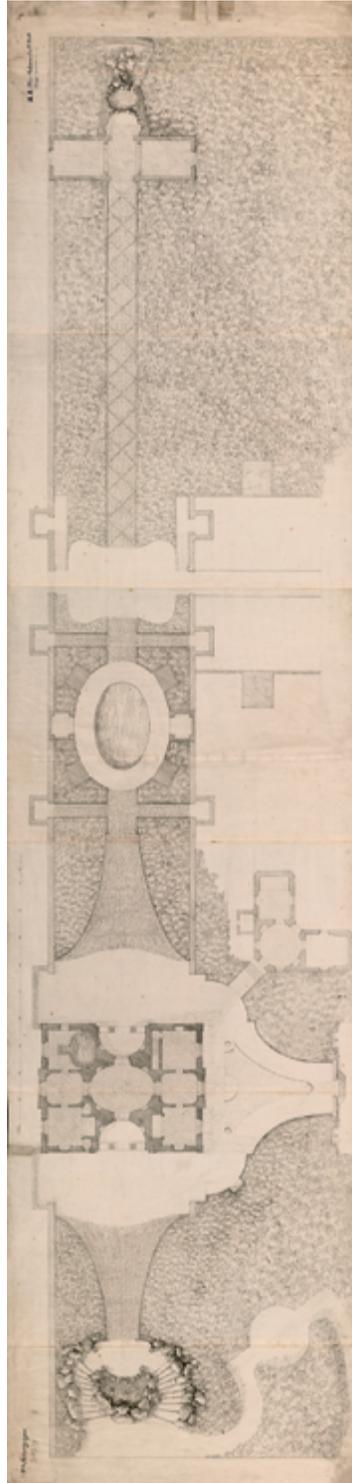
Nicolas de Pigage: Badhausplan, o. J.
